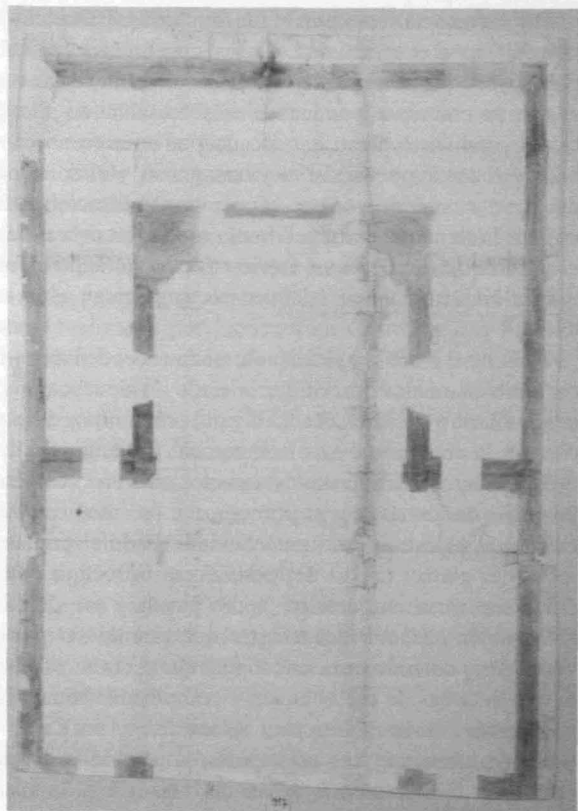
Planta del proyecto de Laviesca para el crucero de la ermita de Nuestra Señora del Lledó en Castellón. A.R.V., Mapas y Planos, 397.
